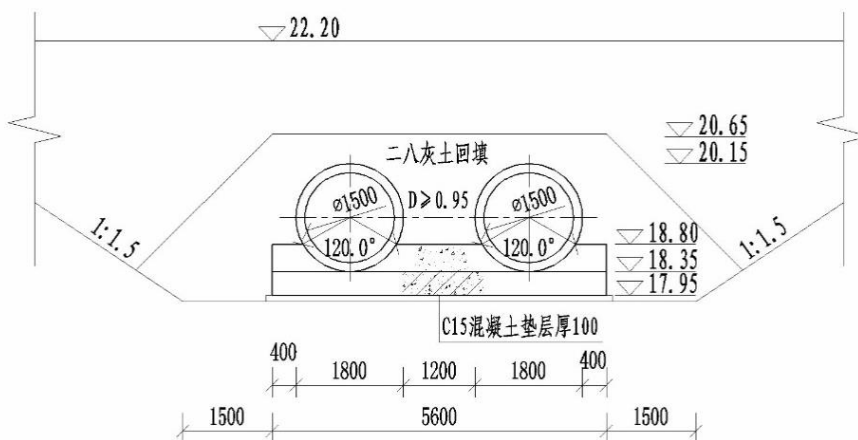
2孔 DN1500 交通涵典型设计横断面图
